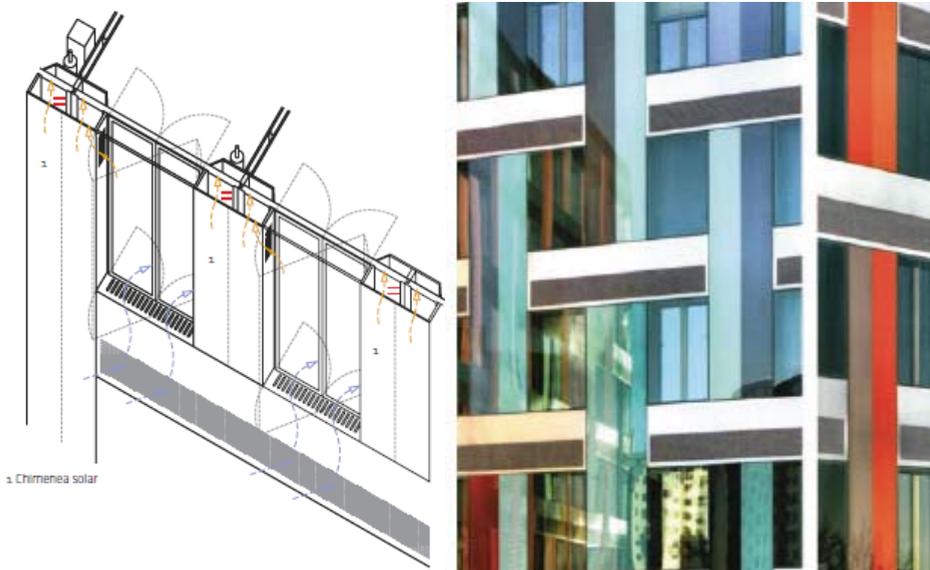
Detalle e imagen de la fachada con la chimenea solar. Jessop West.
